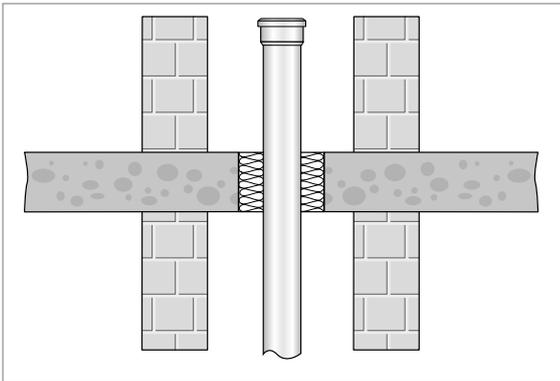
Esempio di esecuzione 2 - Posa in pozzetti di installazione
